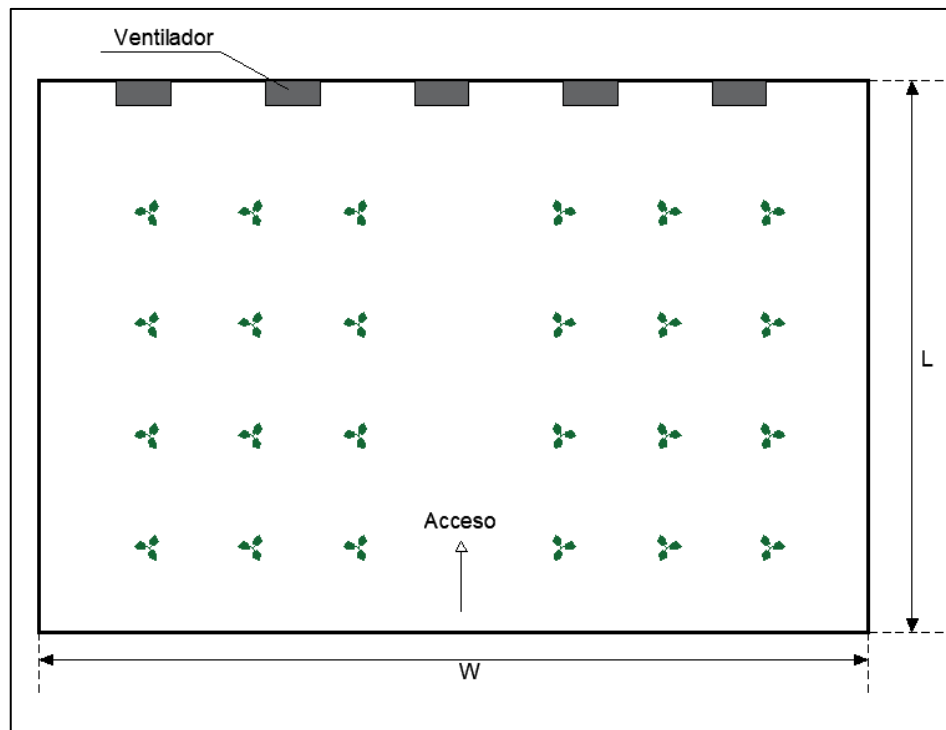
Vista esquemática de la distribución en planta de los ventiladores en el invernadero
